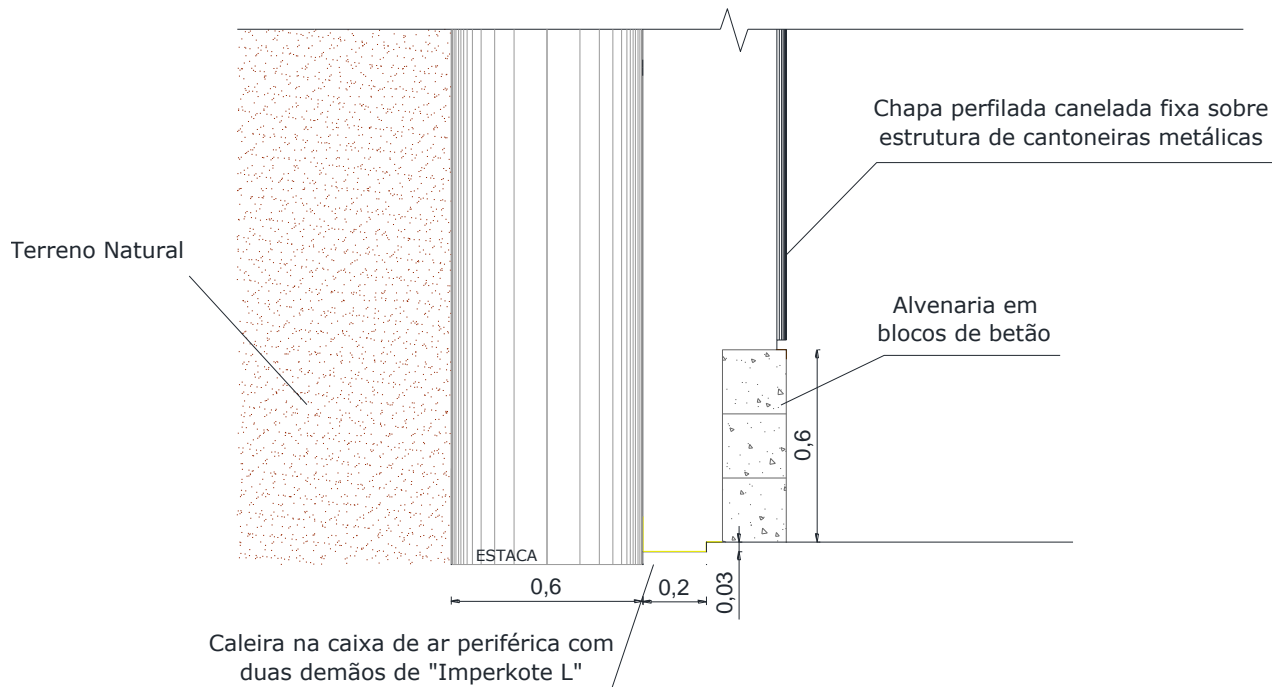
Corte estrutural na zona de pendente mínima do piso -1.
